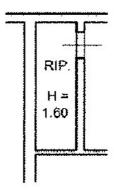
Planimetria del ripostiglio al piano ammezzato (sub 15)
